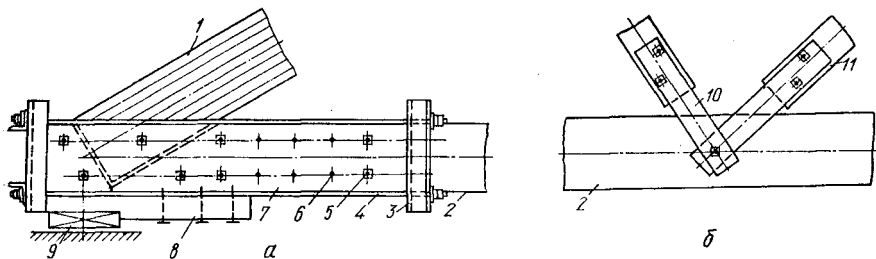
Узлы сегментной цельнодеревянной фермы из клееных элементов:
